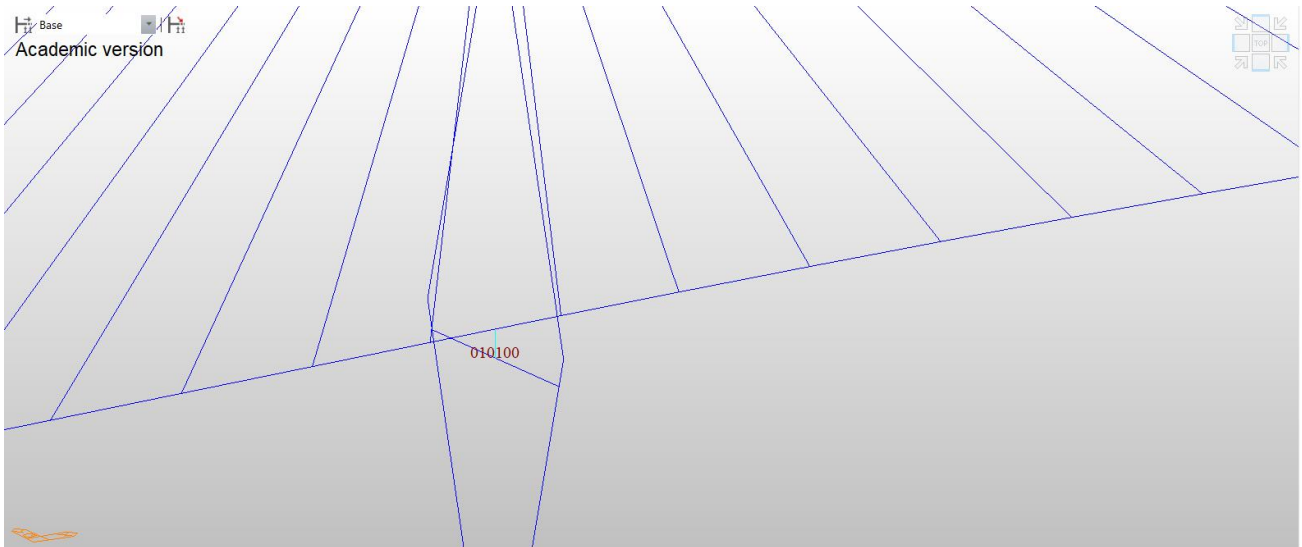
Rigid link tablero con vigas pilonos
